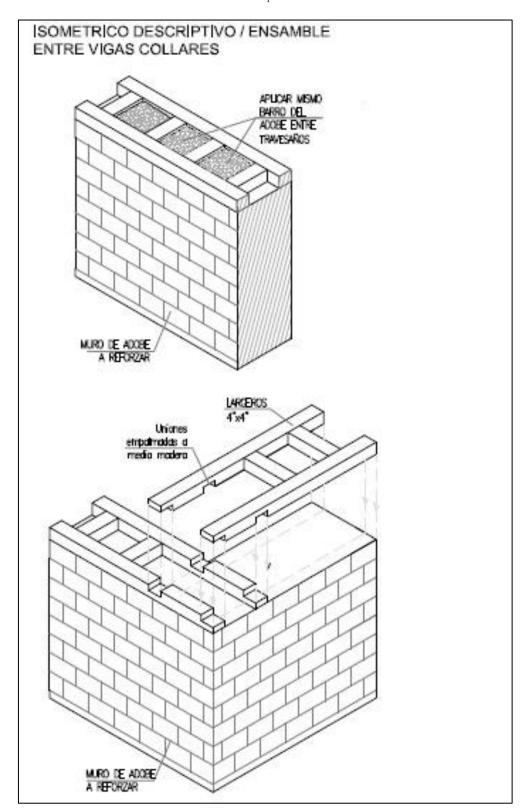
Proceso de reparación de vivienda adobe Peralillo. Fuente: Proyecto reconstrucción Zócalo arquitectura.
